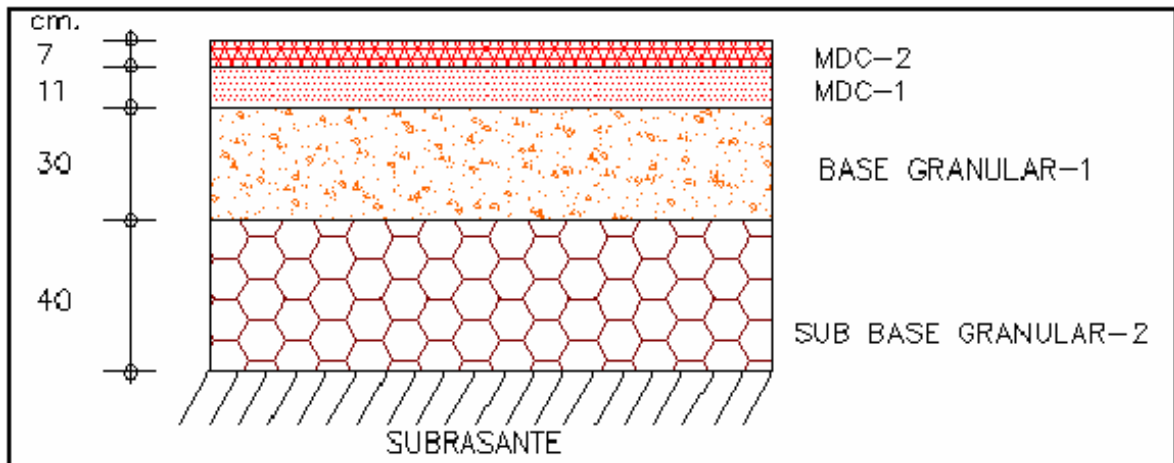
Estructura de Pavimento K7+600-K12+543 Occidental
